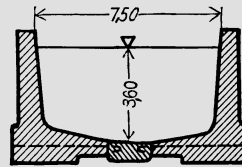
Betonkanäle mit Stützmauer. (Plattenkanal). Maßstab 1 : 300.
